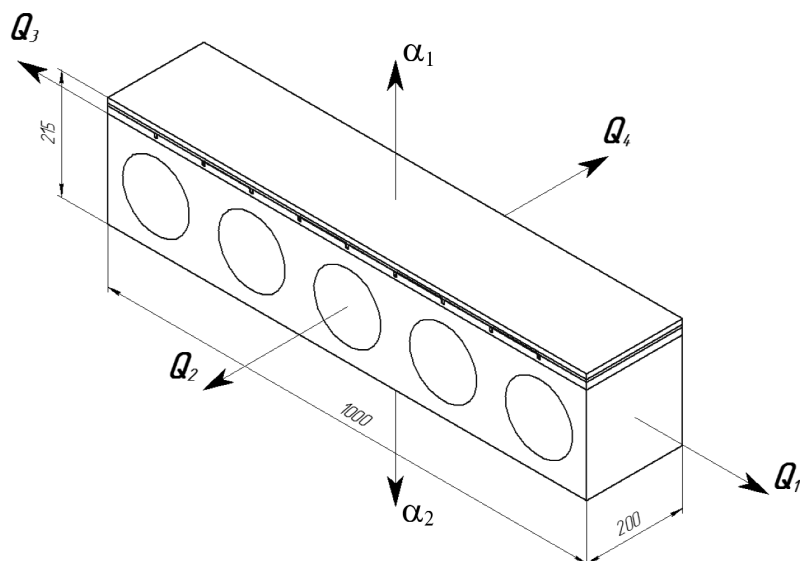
Схема модели участка „теплого пола” на панели перекрытия.
